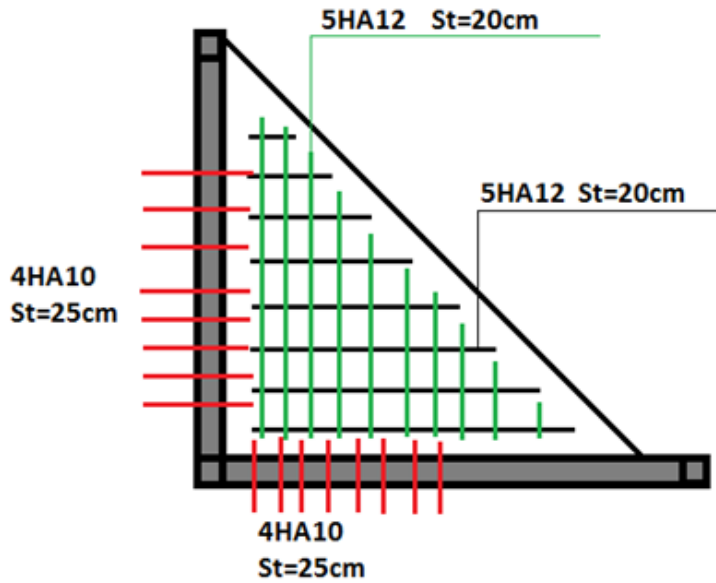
schéma de ferrailage de la dalle sur deux appuis D2
